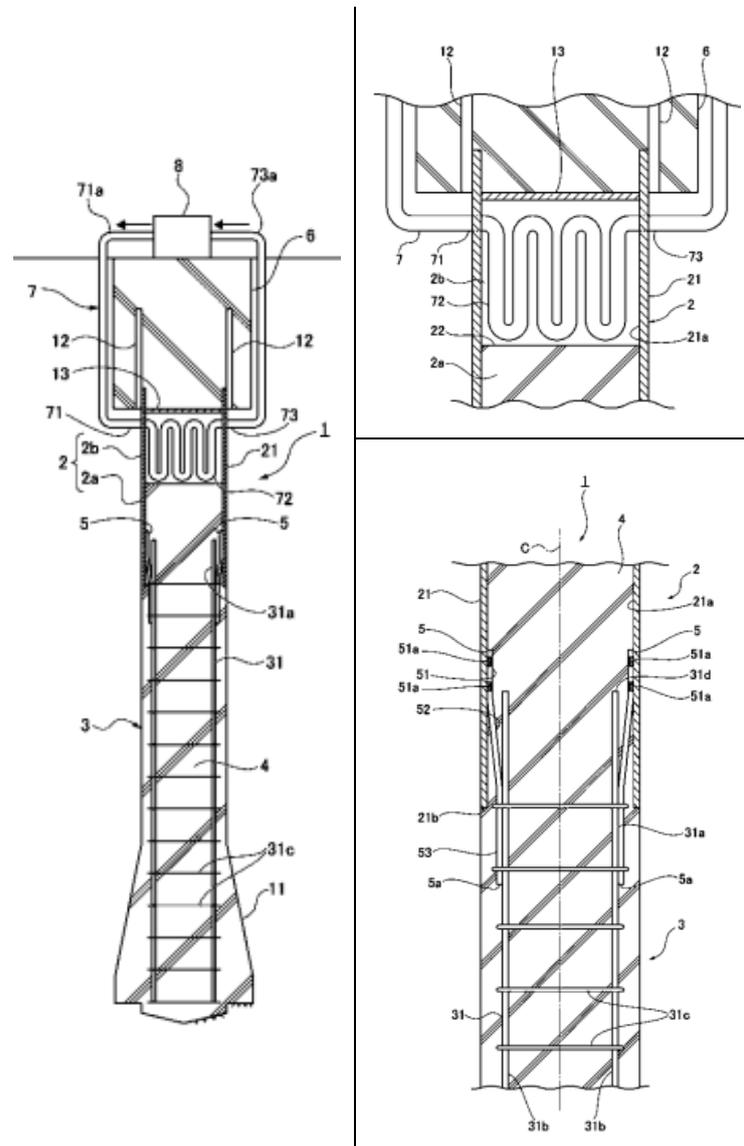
Cimentación geotérmica de la patente JP 6240846 B2 (izq.) junto con vista detallada de los tubos del colector (arriba, der.) y la parte de hormigón reforzado (debajo, der.)
